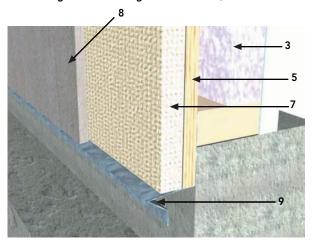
95: Vista exterior de la zona baja del tabique perimetral con los diferentes componentes.
